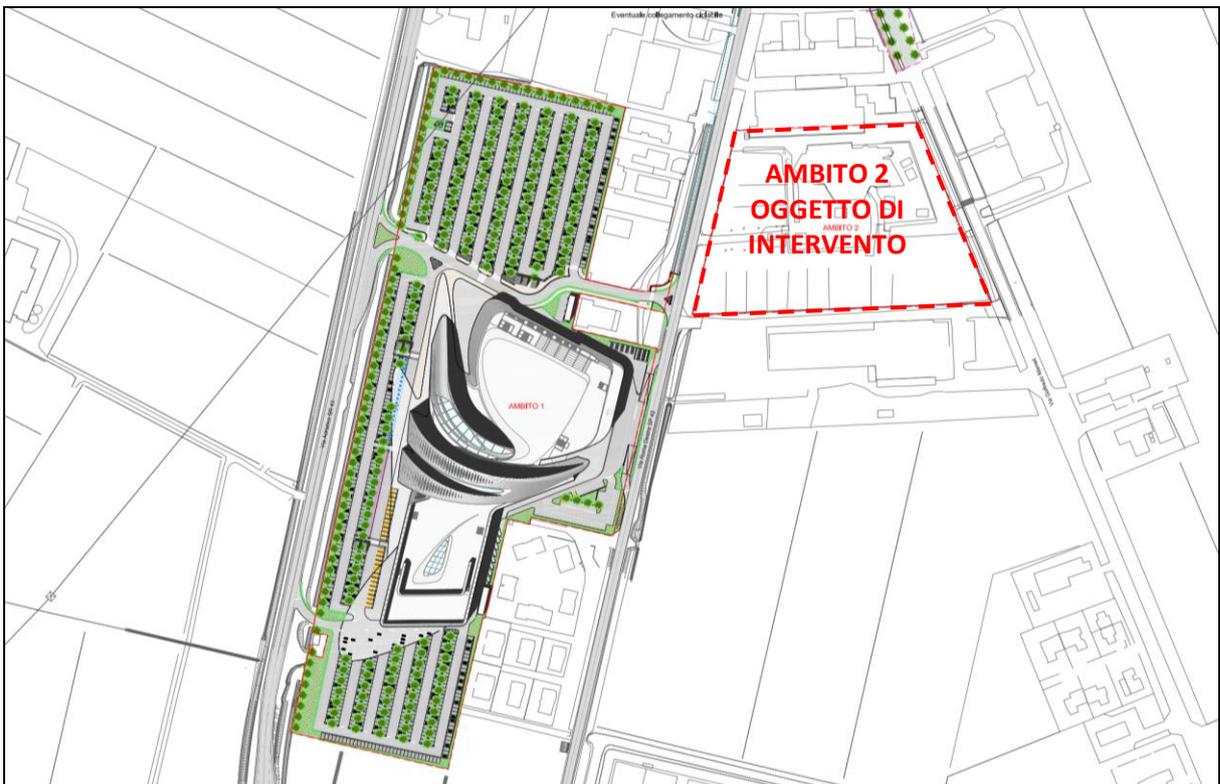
Individuazione ambito di intervento (Estratto dalla Tav.10 PUA Adottato)
